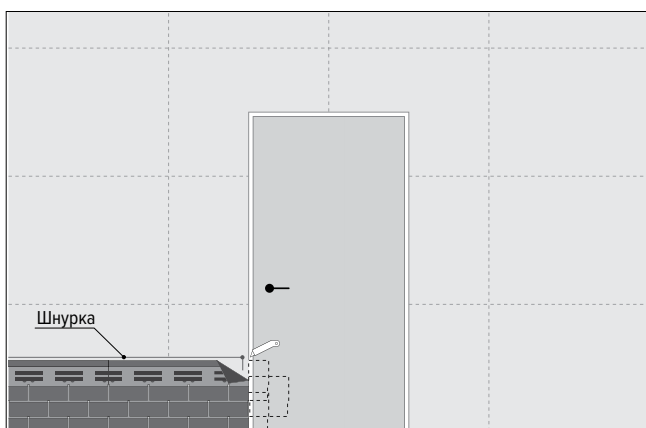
Монтаж фасадной плитки вокруг дверных проемов
